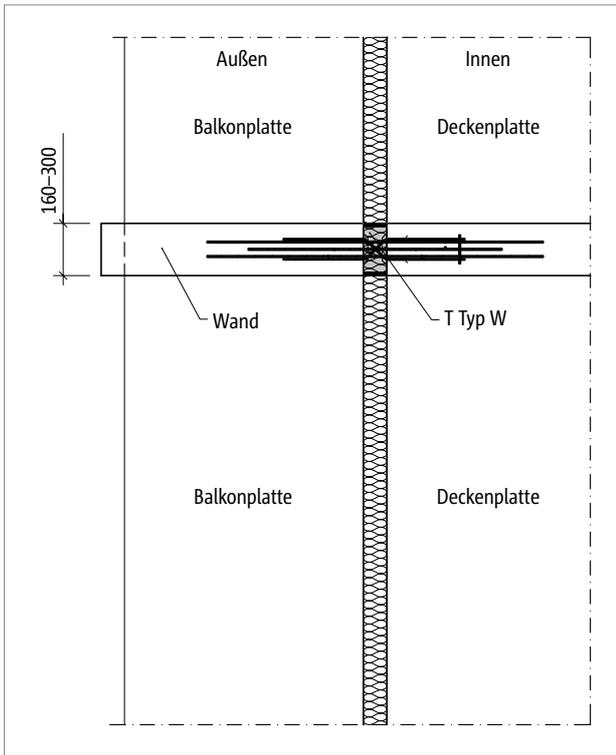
Schöck Isokorb® T Typ W: Grundriss; Balkonkonstruktion mit wärmegeämmten tragenden Wandscheiben
